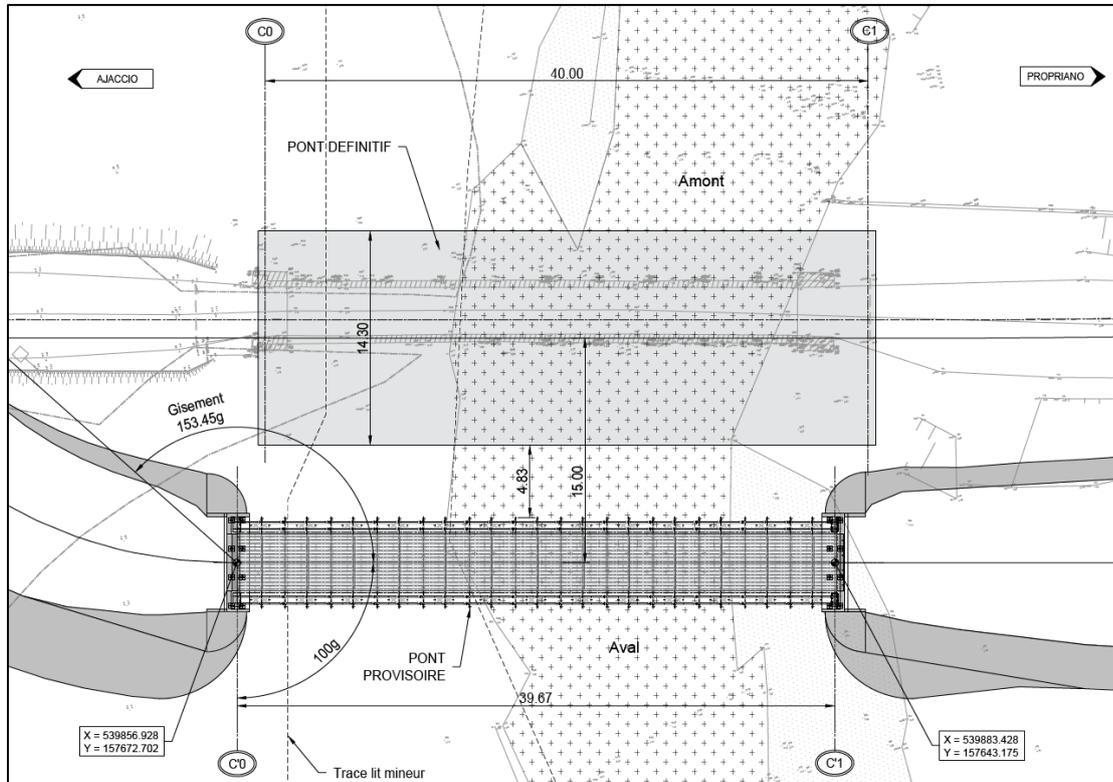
Vue en plan de l'ouvrage provisoire (Source : Arcadis)
